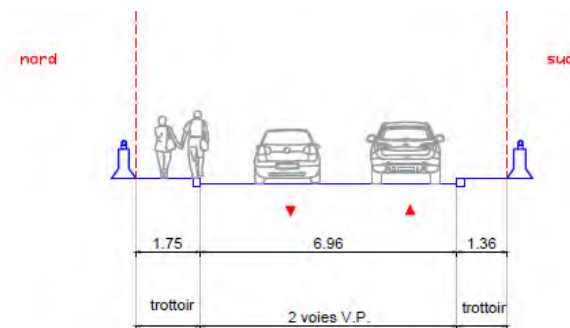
Coupe en travers de l'ouvrage OA3 franchissant la Marina Disney
